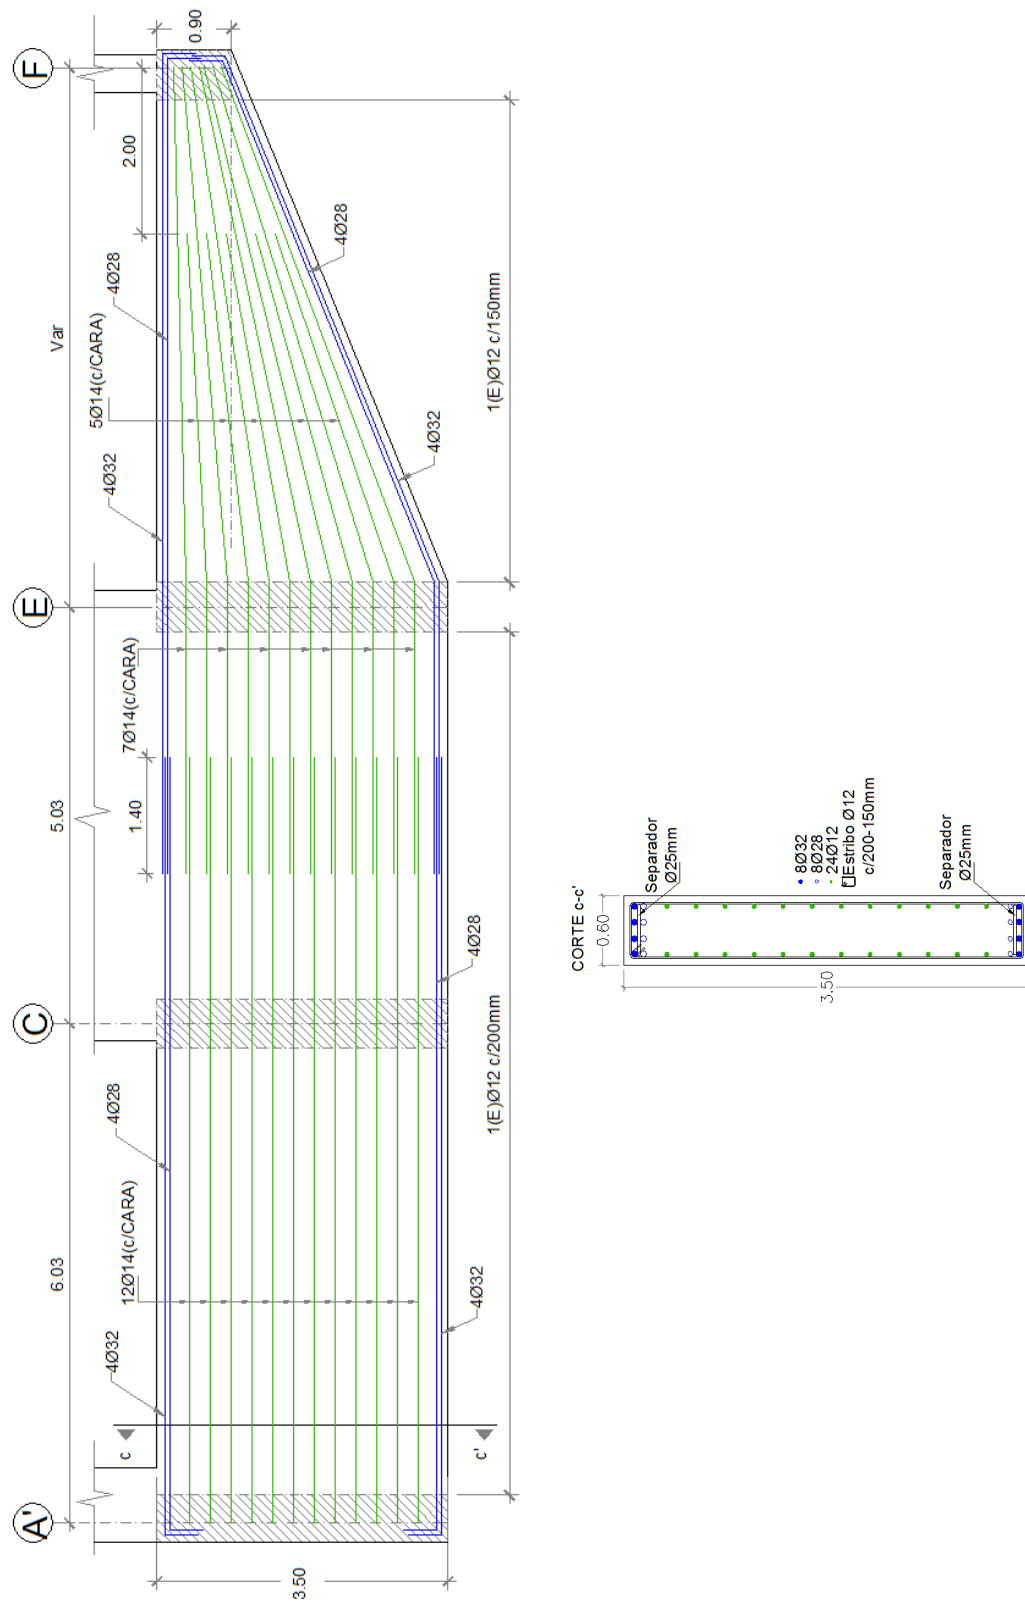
Viga de cimentación eje 3, 4, 5, 6.
